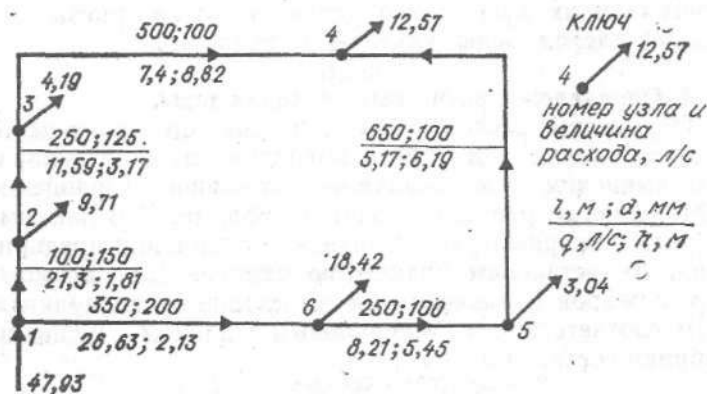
Расчетная схема наружной водопроводной сети до пожара
